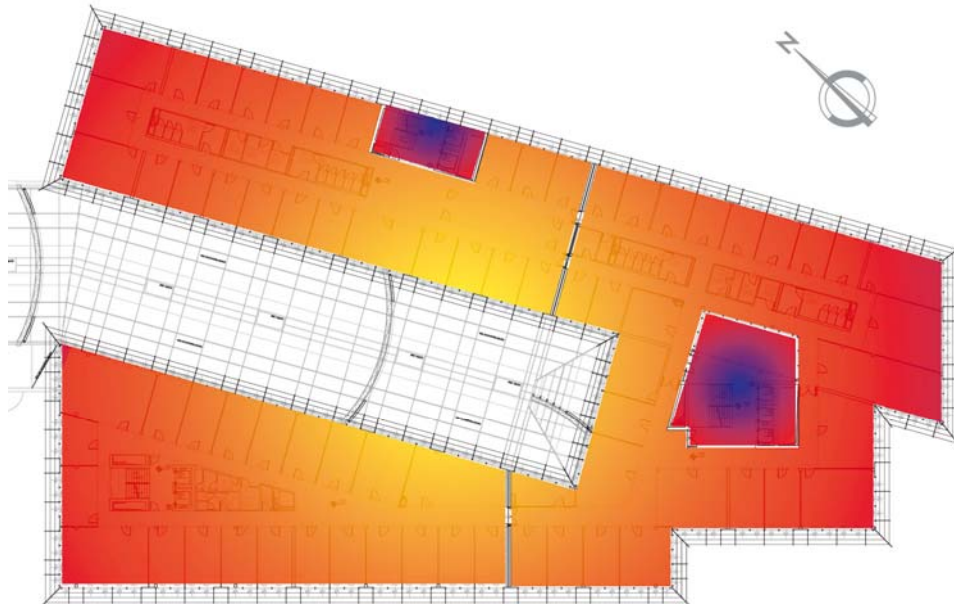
Grundriss BÜRO: beheizte und unbeheizte Zonen
